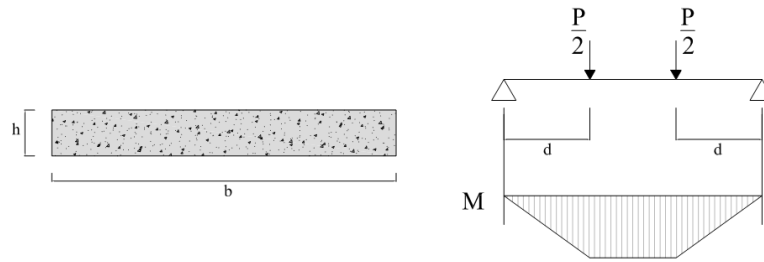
Sezione del travetto strutturale e andamento del momento nella trave soggetta a flessione su quattro punti
